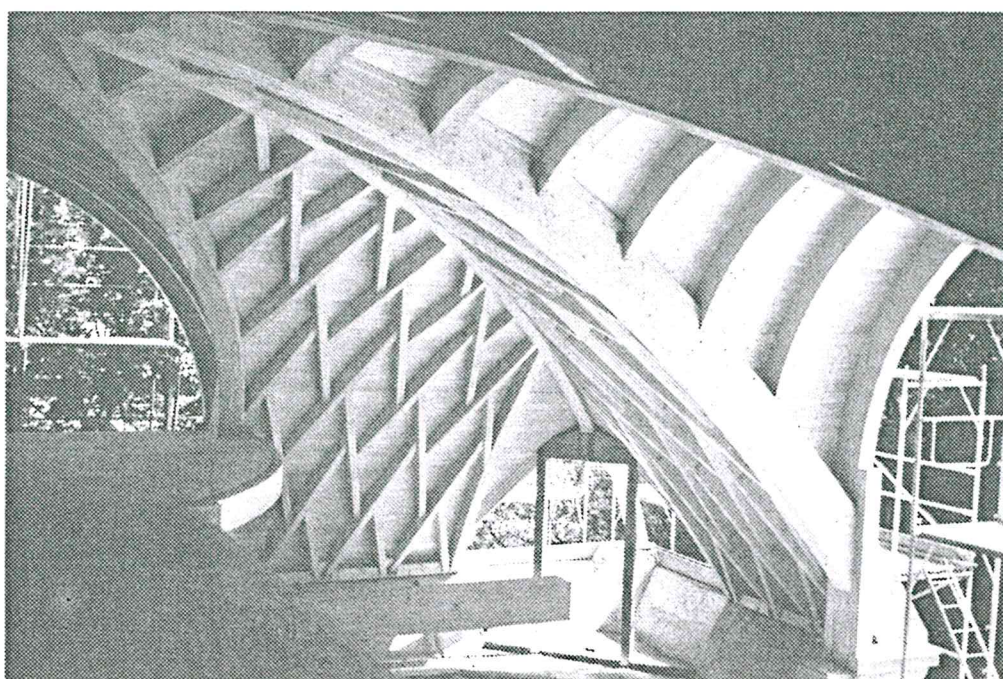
Dachkonstruktion für ein Wohn- und Geschäftshaus in Berlin mit sichtbarer Zollbau-Lamellen-Struktur
